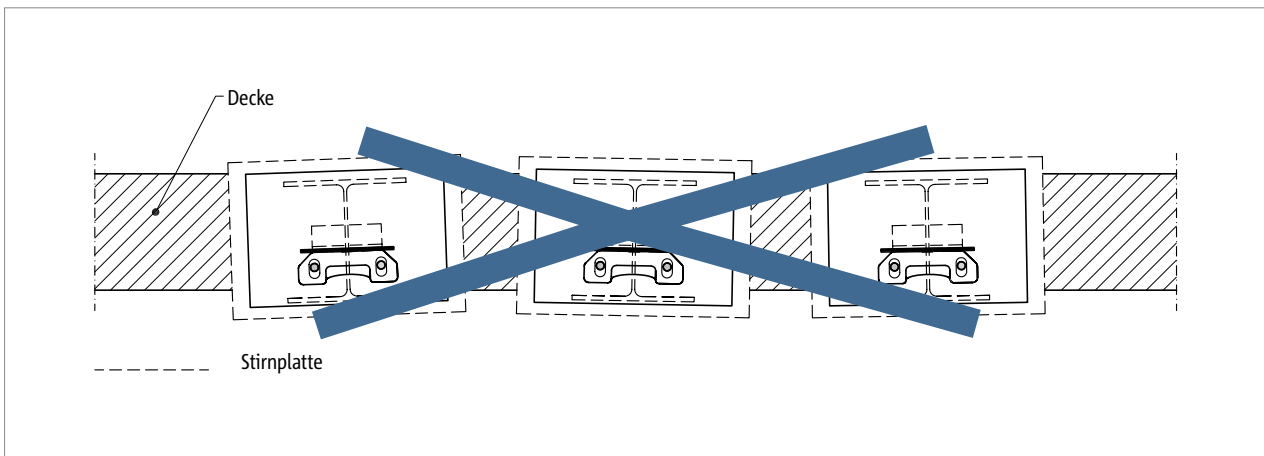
Schöck Isokorb® RT Typ SQ: Verdrehte und verschobene Elemente durch ungenauen Einbau
